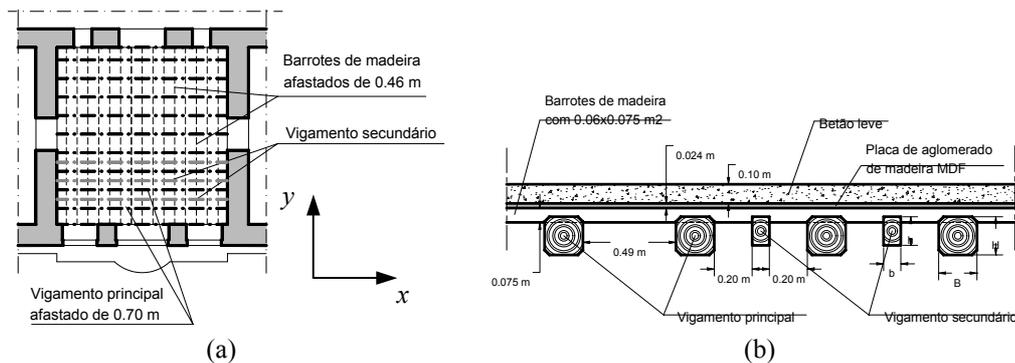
Planta estrutural do pavimento do 1º andar na zona onde se realizou o ensaio de carga; e (b) secção em corte do pavimento em estudo
